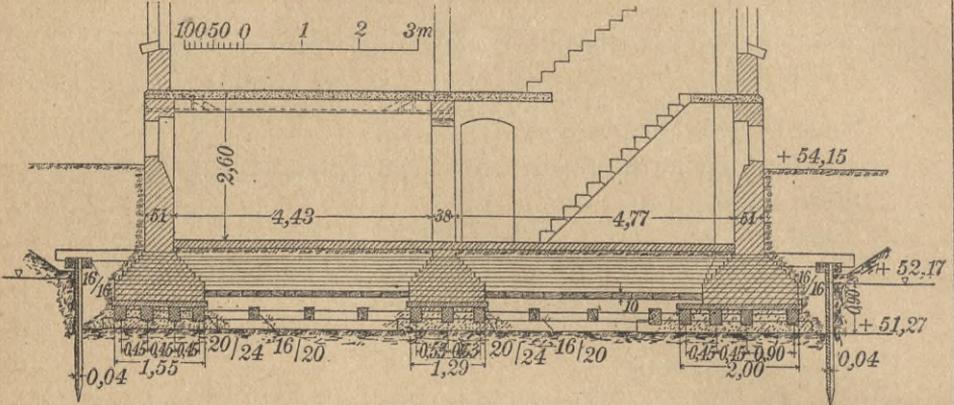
Gründung eines freistehenden Wohnhauses auf Schwellrost. (Umschließung der Baugrube mit einer Stülpwand.)
